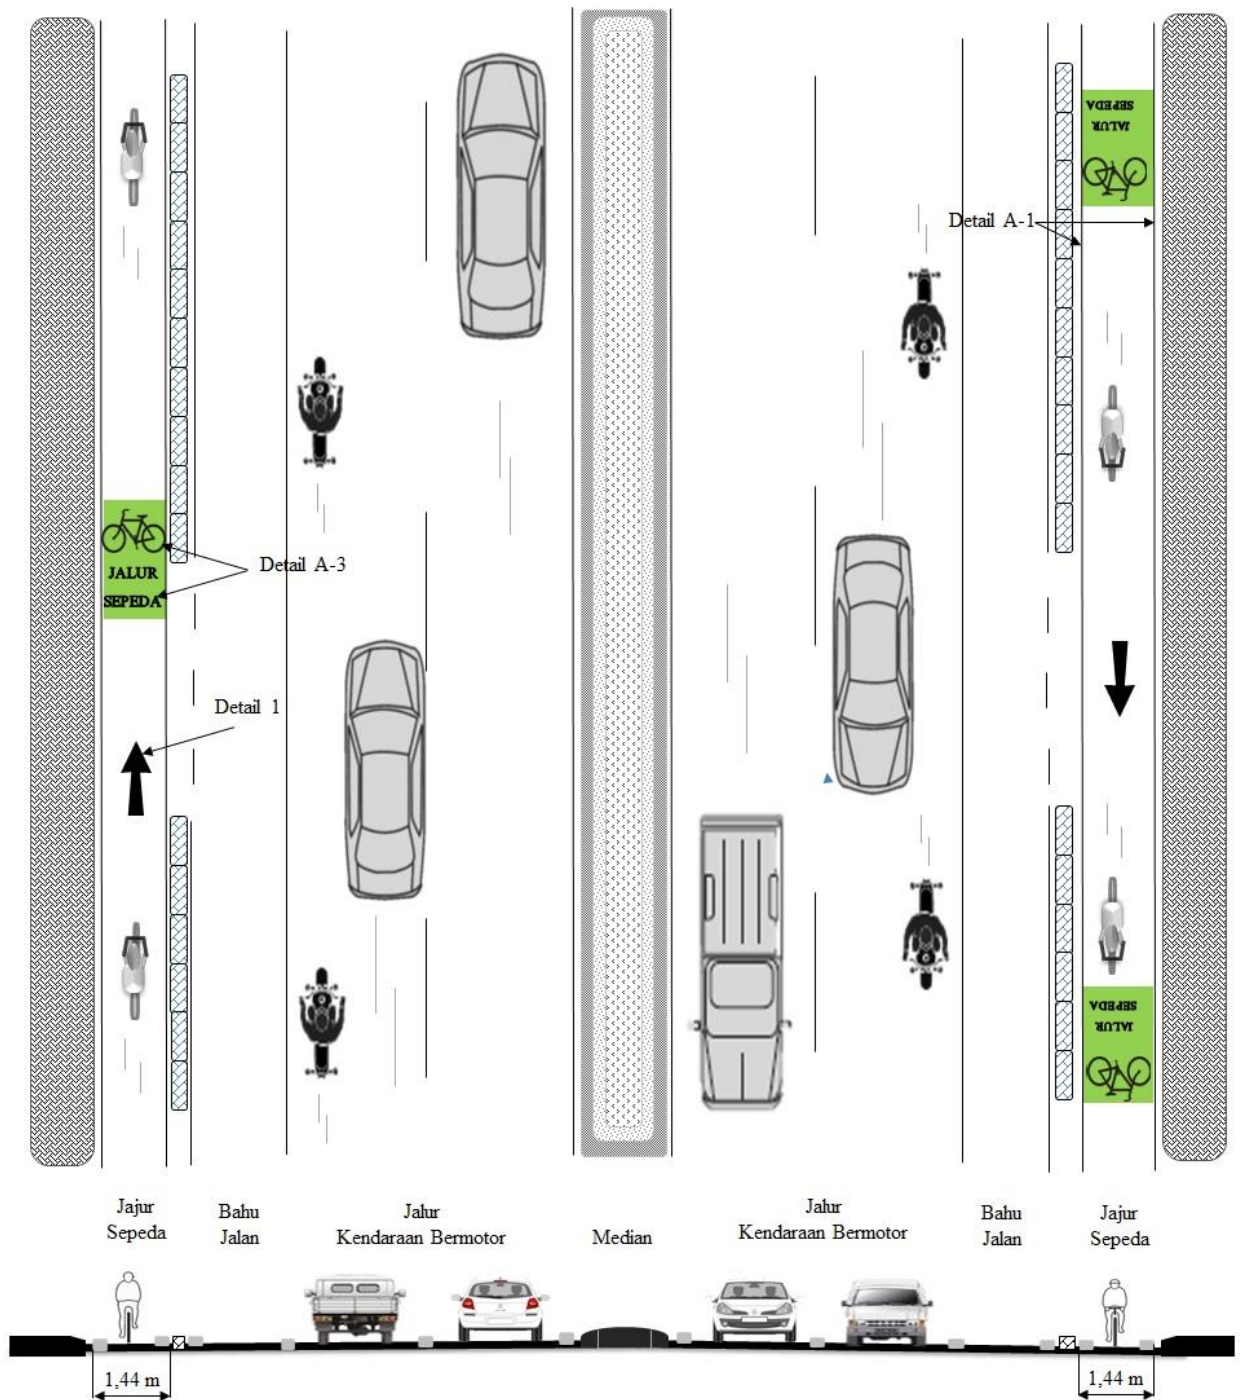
Perspektif Jalur sepeda dengan proteksi jalur hijau
